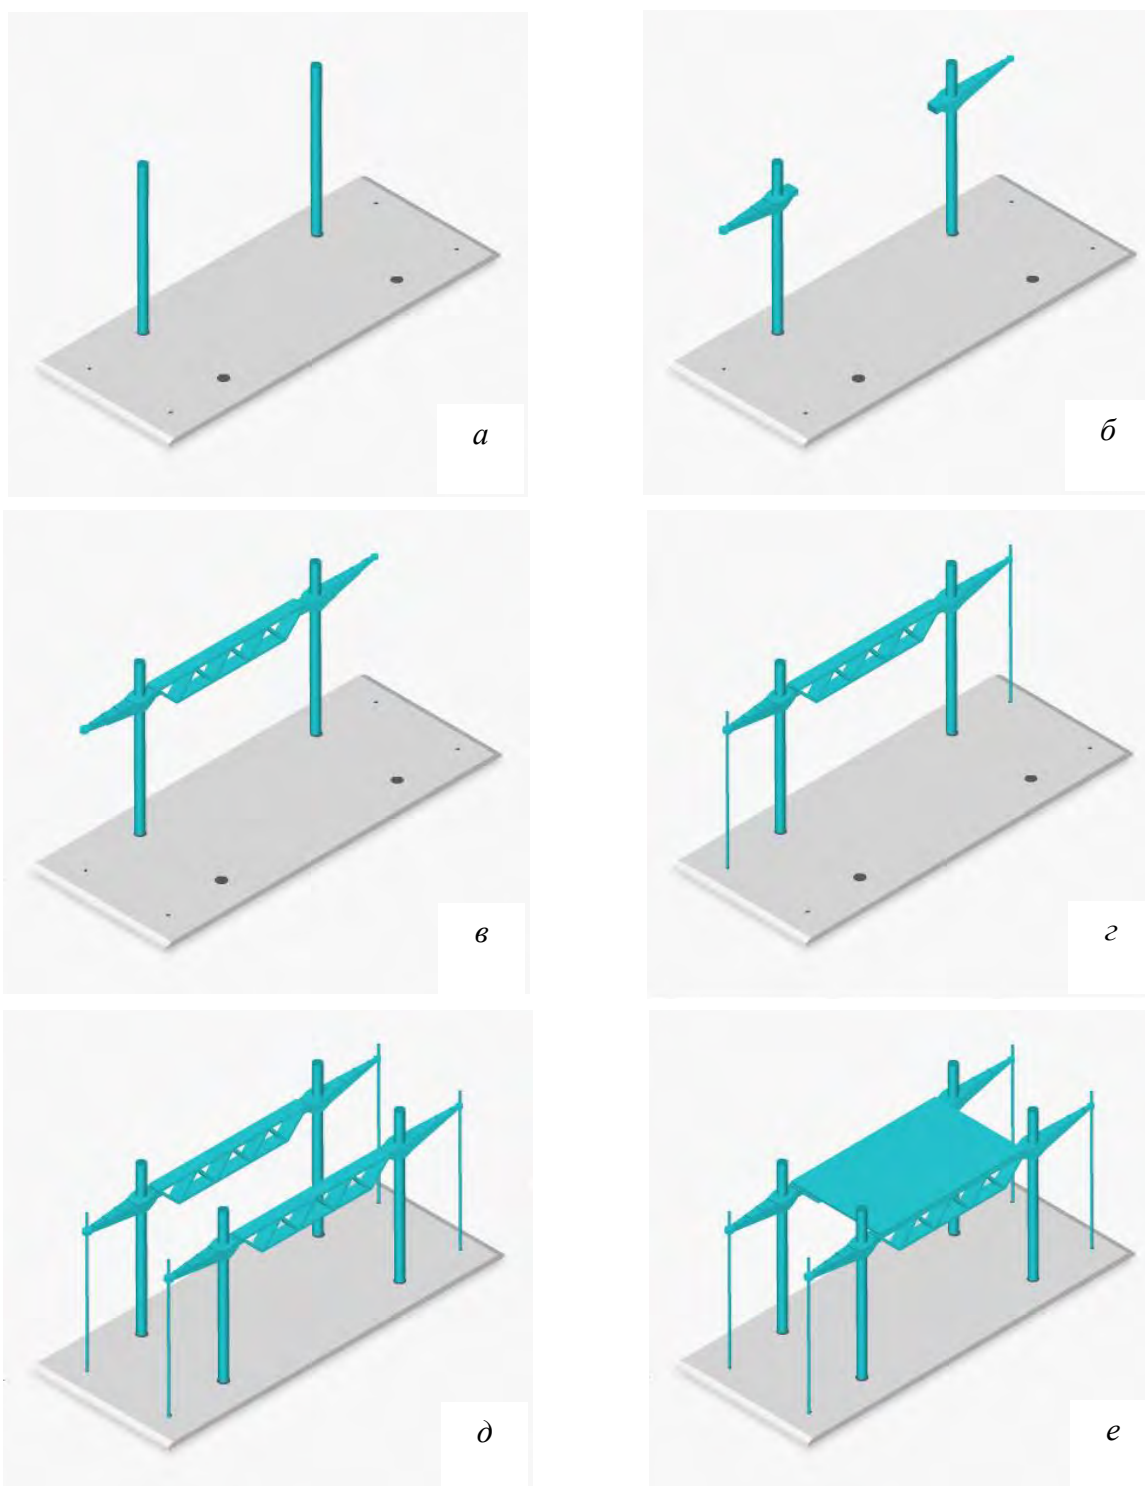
Последовательность сборки каркаса здания: *а* – установка двух колонн диаметром по 85 см на расстоянии в осях 48 м друг от друга; *б* – на каждой колонне прикрепляется герберетта длиной 8 м с резьбой; *в* – на изголовья двух герберетт опирается ферма длиной 45 м; *г* – через конец кронштейна герберетты протягивается стальной прут, воспринимающий нагрузку на растяжение; *д* – два комплекса из колонн, герберетт, ферм и растяжек, т. е. две рамы каркаса, устанавливаются на расстоянии 13 м друг от друга; *е* – на две рядом расположенные рамы опирается пол => образуется пролёт
